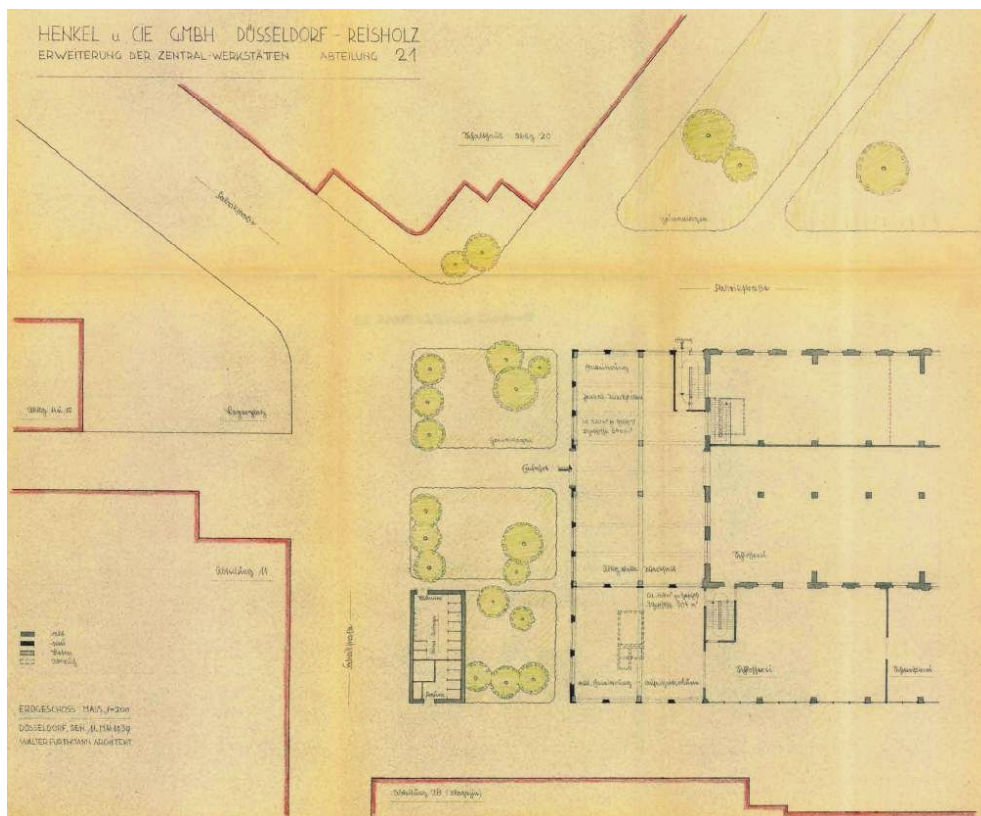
Entwurf zur Erweiterung der Zentralwerkstätten, Abteilung 21, Lageplan mit Grundriss-Erdgeschoss vom 11. Mai 1939 – Architekt: Walter Furthmann
